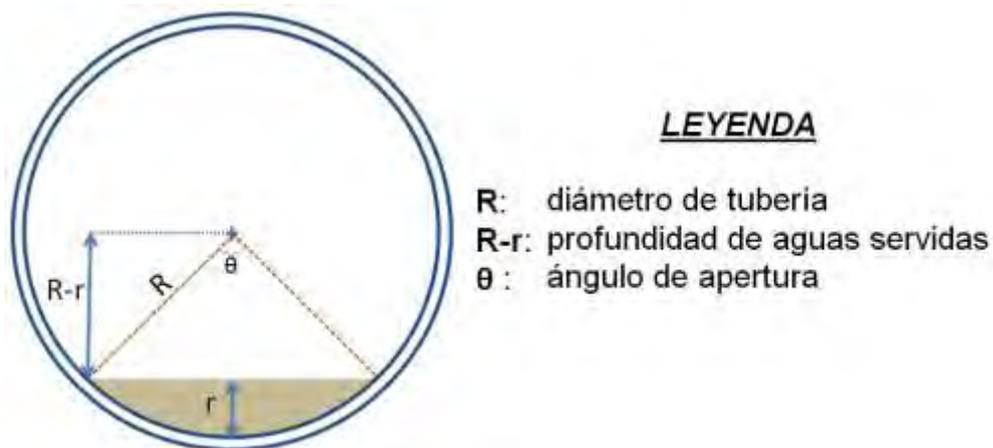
11: Bosquejo de sección transversal de tubería de alcantarillado
